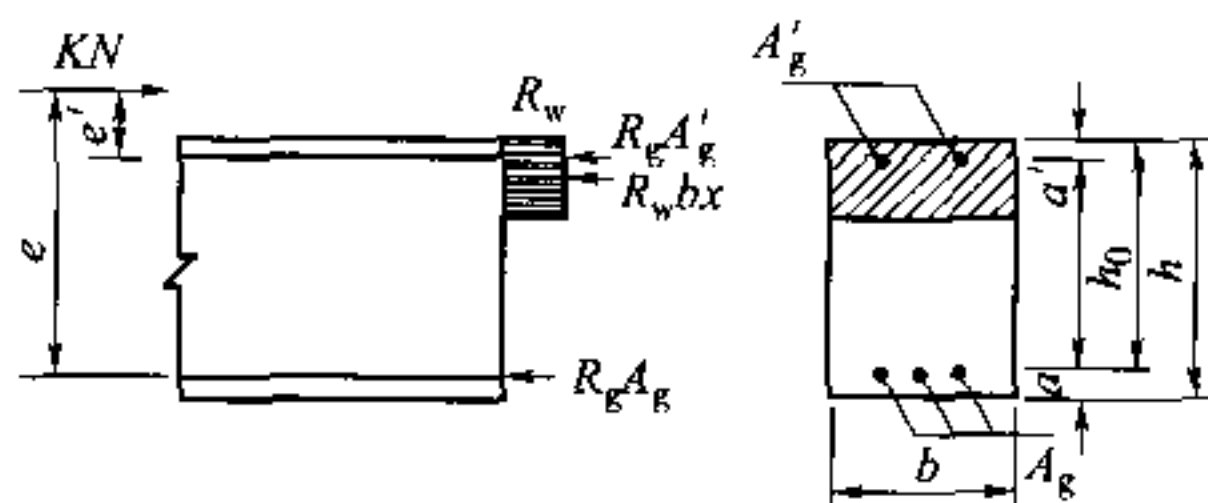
钢筋混凝土大偏心受压构件截面强度计算
